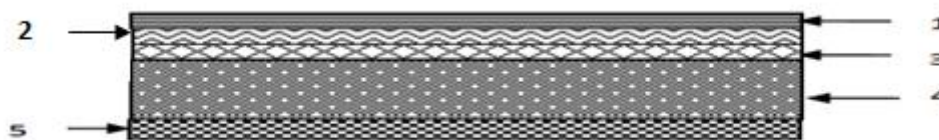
Coupe transversale du plancher en dalle pleine.
